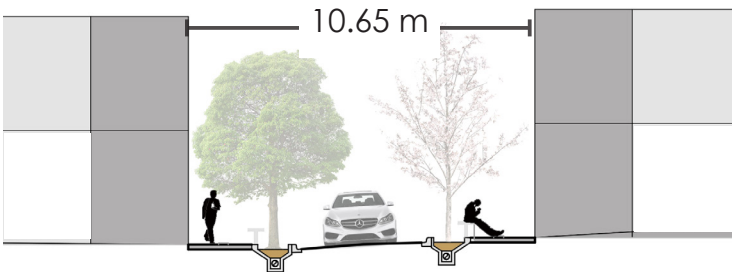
Corte E-E Jardines pluviales zonas angostas
